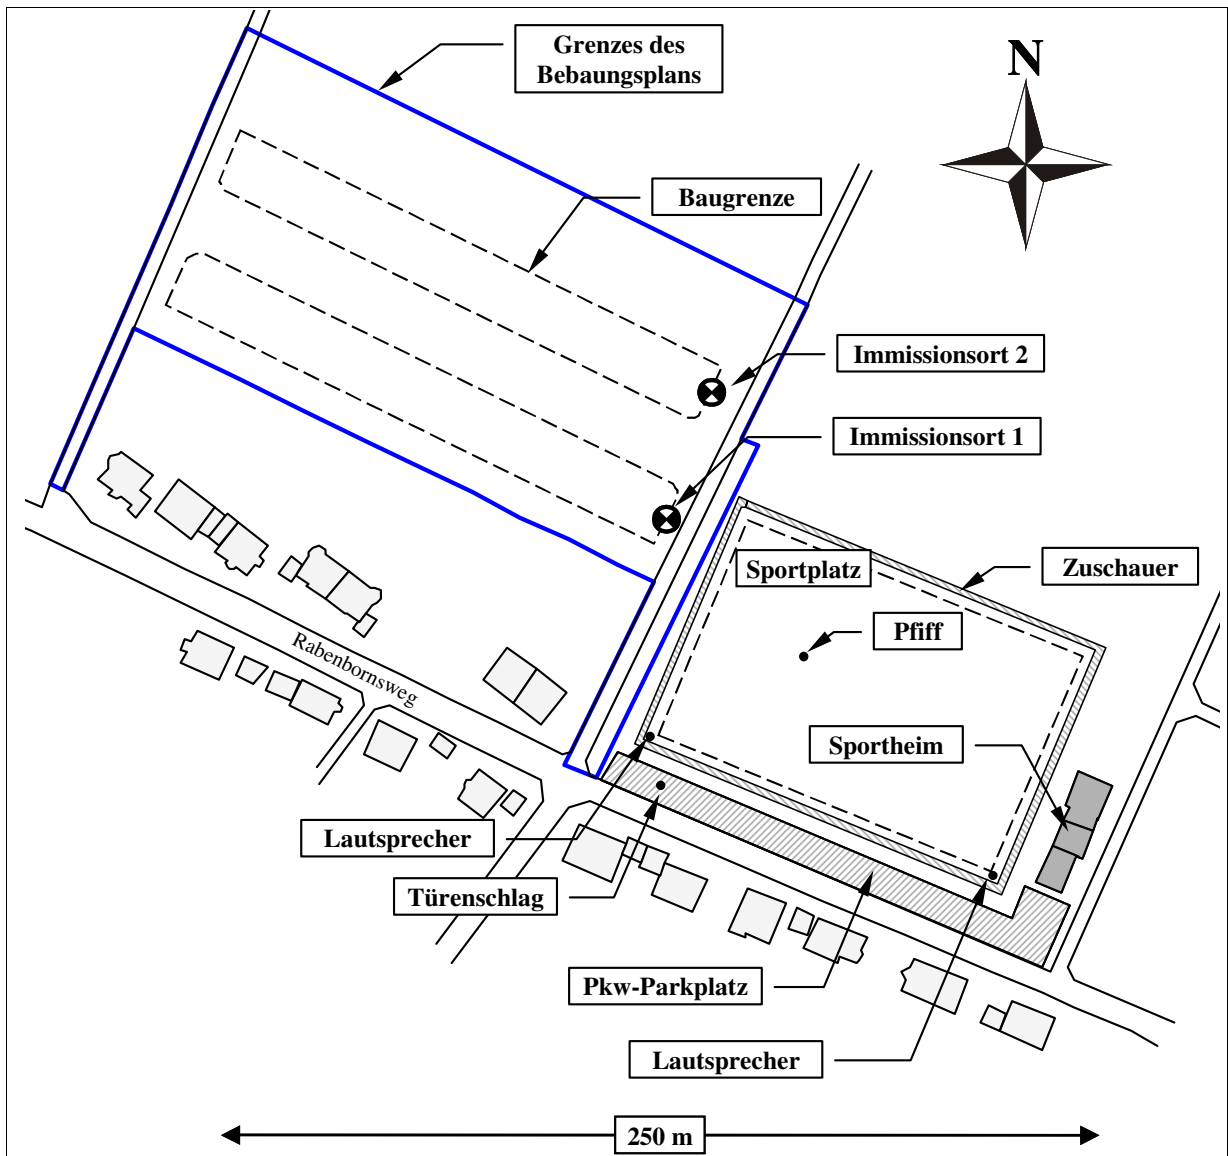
Lageplan des Gebietes mit Kennzeichnung der Immissionsorte und der Geräuschquellen.
